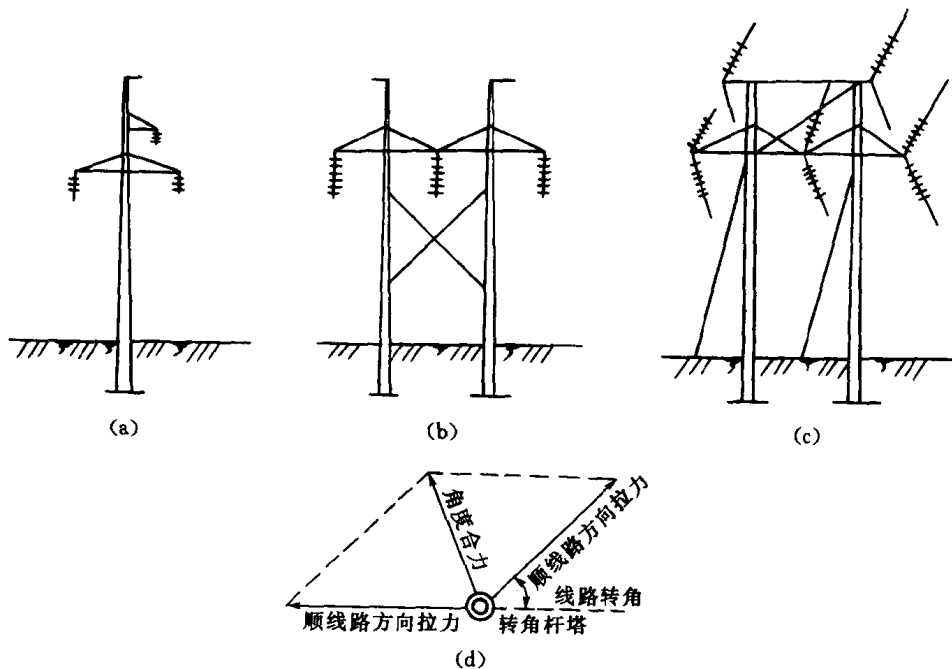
钢筋混凝土杆塔杆型及转角杆塔的受力图
